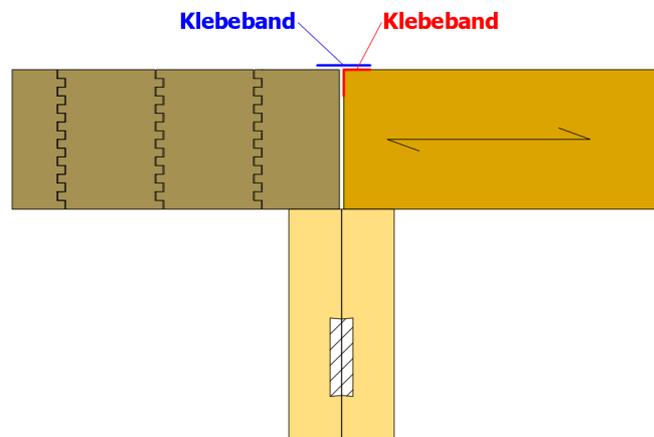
Le fughe che si creano durante il montaggio devono essere assolutamente chiuse.
